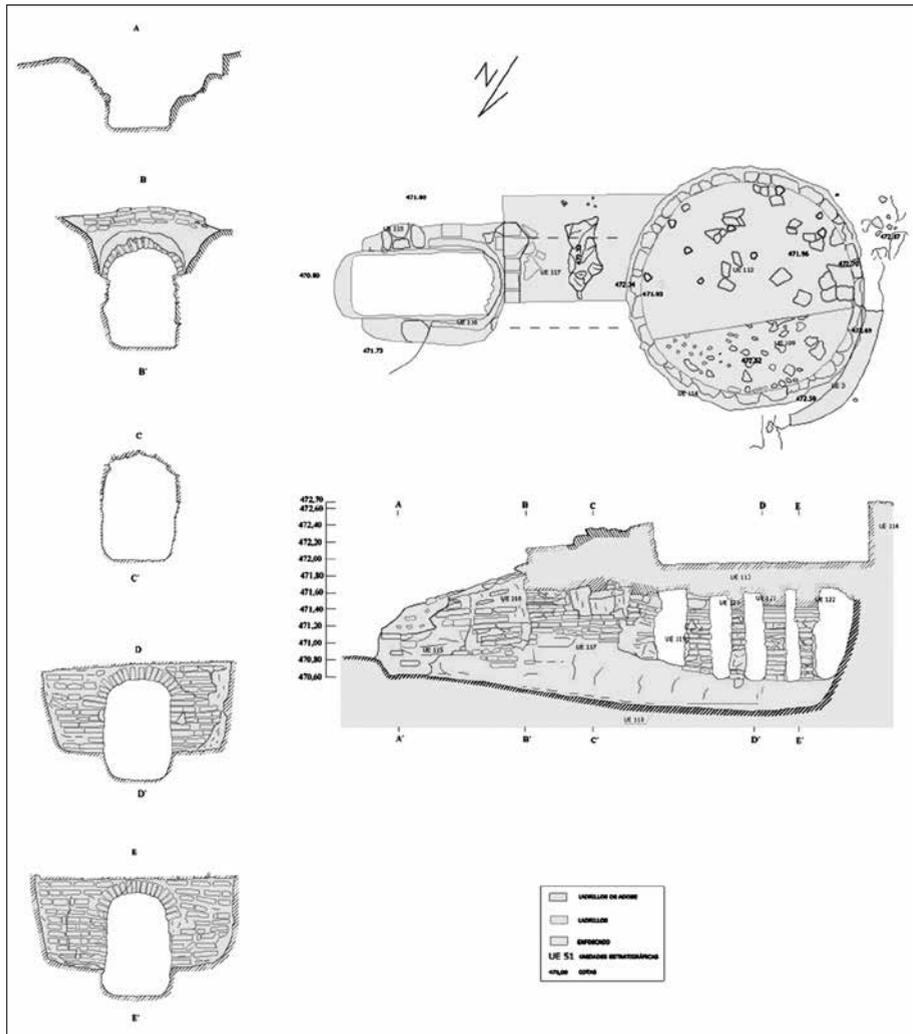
Planta y alzado del horno. Villa de Valsequillo.
